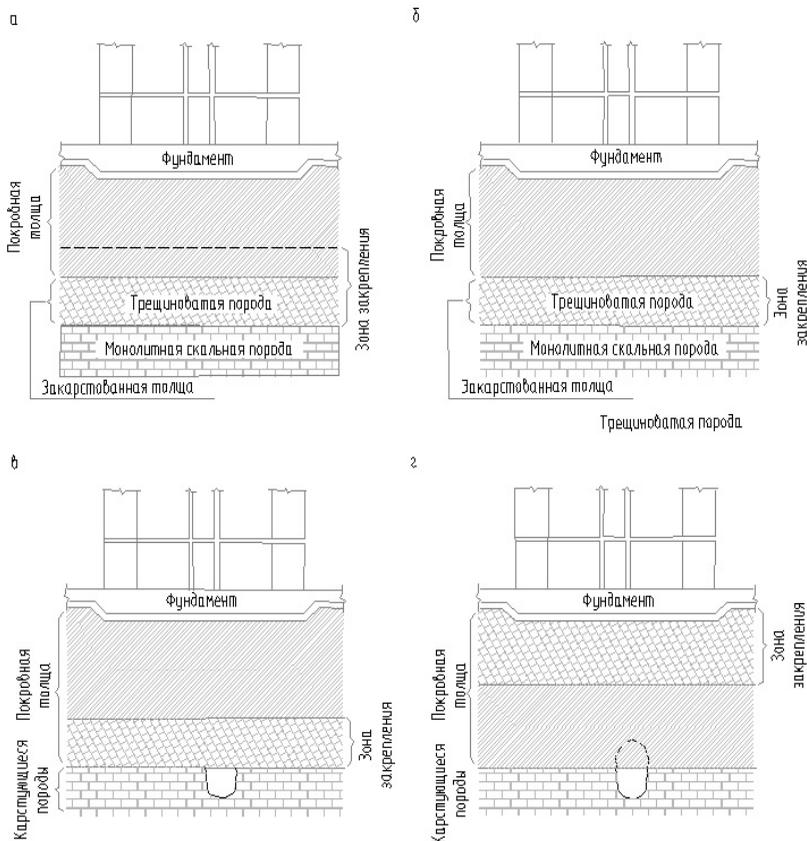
Принципиальные схемы выполнения геотехнических мероприятий (СП 499.1325800): *а* – тампонаж карстующейся и трещиноватой зоны до уровня кровли монолитной (незакарстованной) толщи в сочетании с закреплением толщи покровных отложений; *б* – тампонаж карстующейся и трещиноватой зоны до уровня кровли монолитной (незакарстованной) толщи; *в* – закрепление покровных отложений непосредственно над карстующимися породами; *г* – закрепление толщи грунтов непосредственно под фундаментом здания или сооружения
